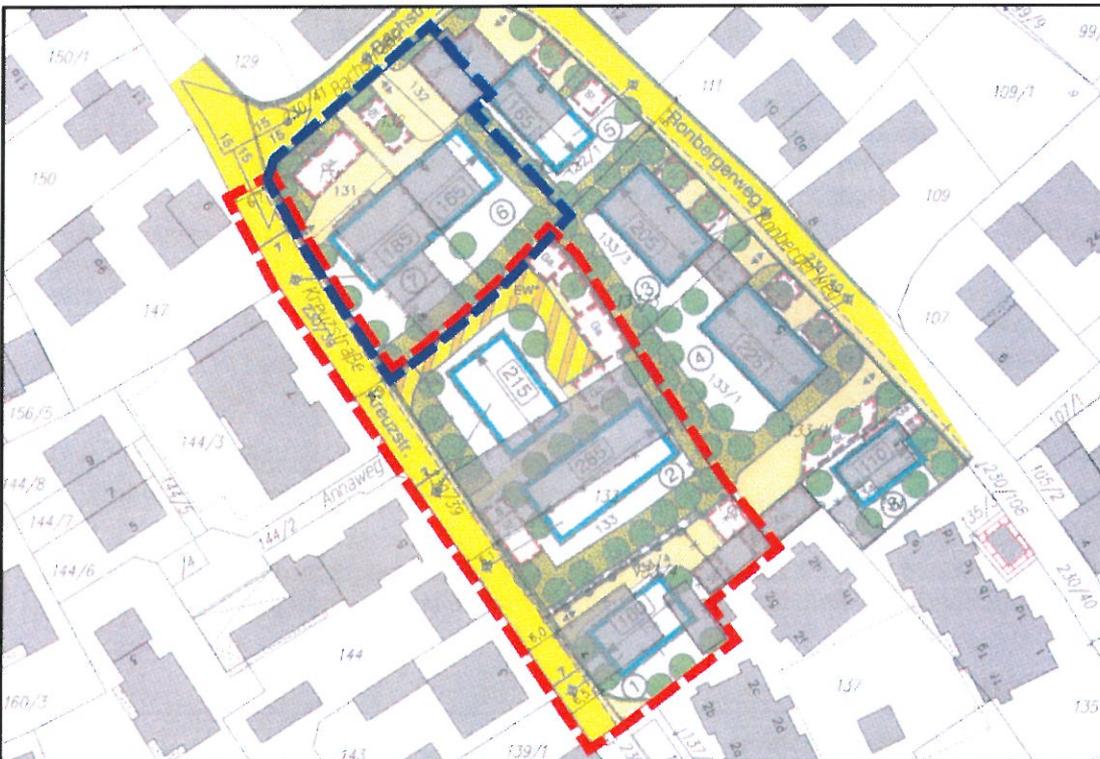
Bebauungsplan "Kreuzstr.-Ronbergerweg" -(rot. Bereich A, blau Bereich B)
